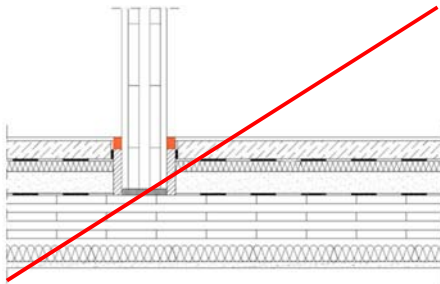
fehlerhafte Ausführung: Koppelung durch Spachtelmasse aufgrund zu früh abgeschnittener Estrichdämmstreifen
